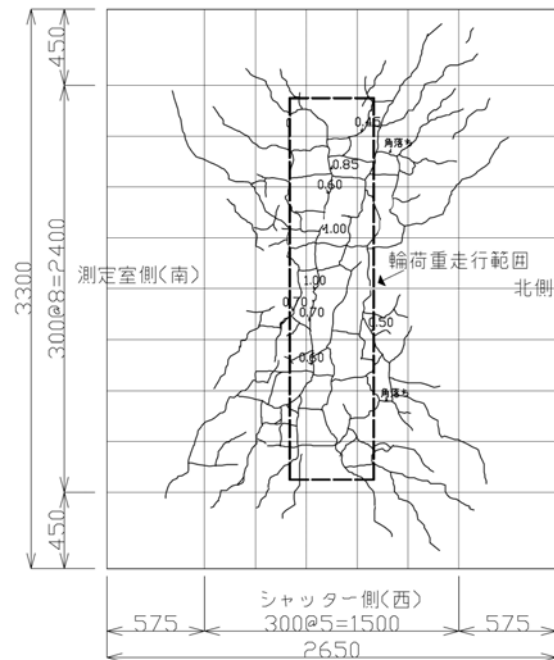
予備載荷後のひび割れ状況 (No. 3)
